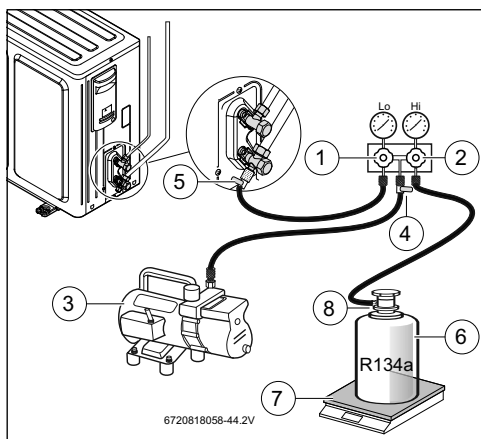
Schéma de montage pour la vidange et le remplissage supplémentaire avec le R134a
